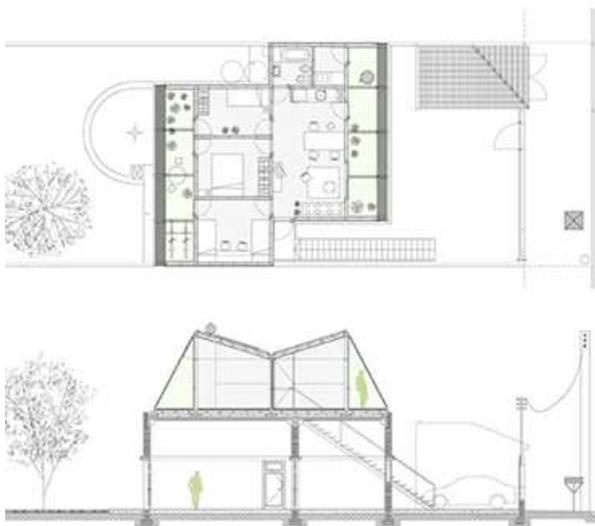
CASAS MUReRE. PLANTA Y ALZADO PROTOTIPO
